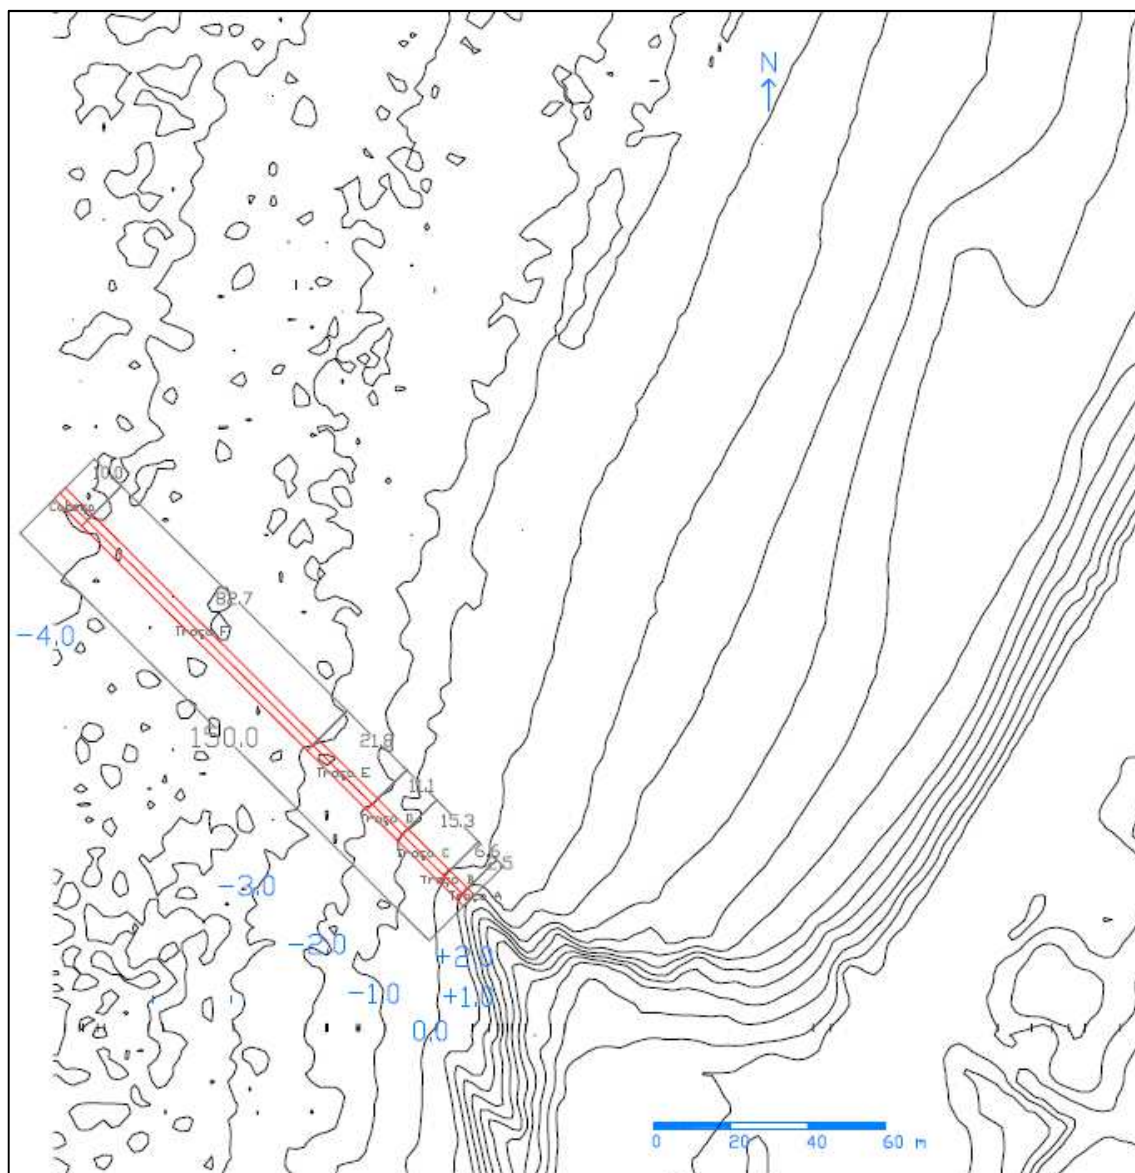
Planta de implantação de esporão em "I" com 150 m de comprimento
